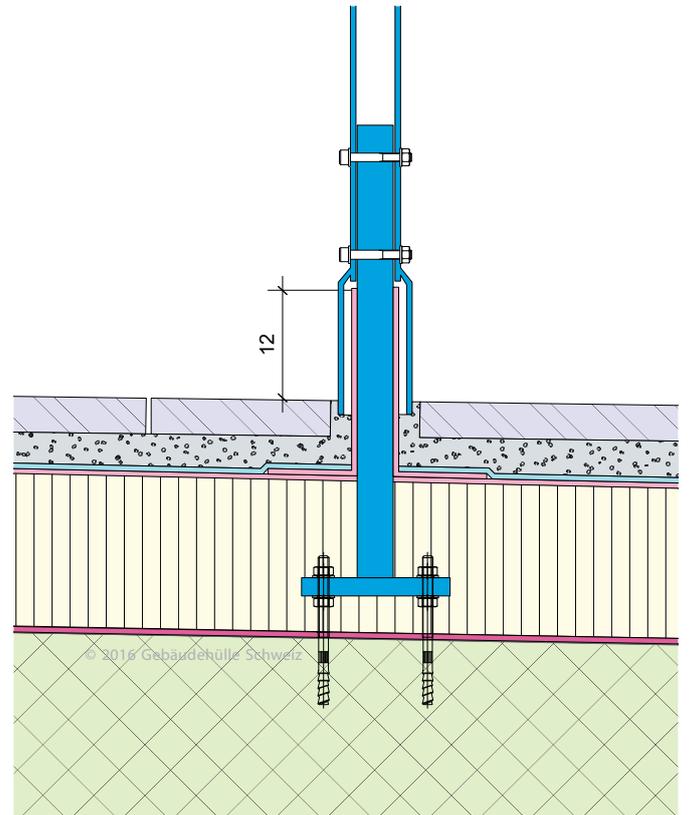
Raccordement d'étanchéité de console de garde-corps ouvert en haut avec garniture plastique et élastomère. Montant de garde-corps avec cloche couvrant le raccordement de l'étanchéité.
